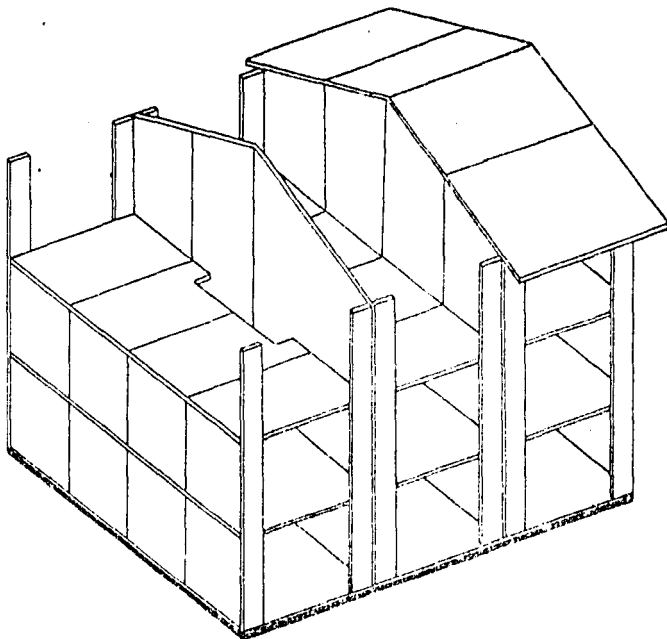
Configuración de un Sistema Constructivo a Base de Paneles
